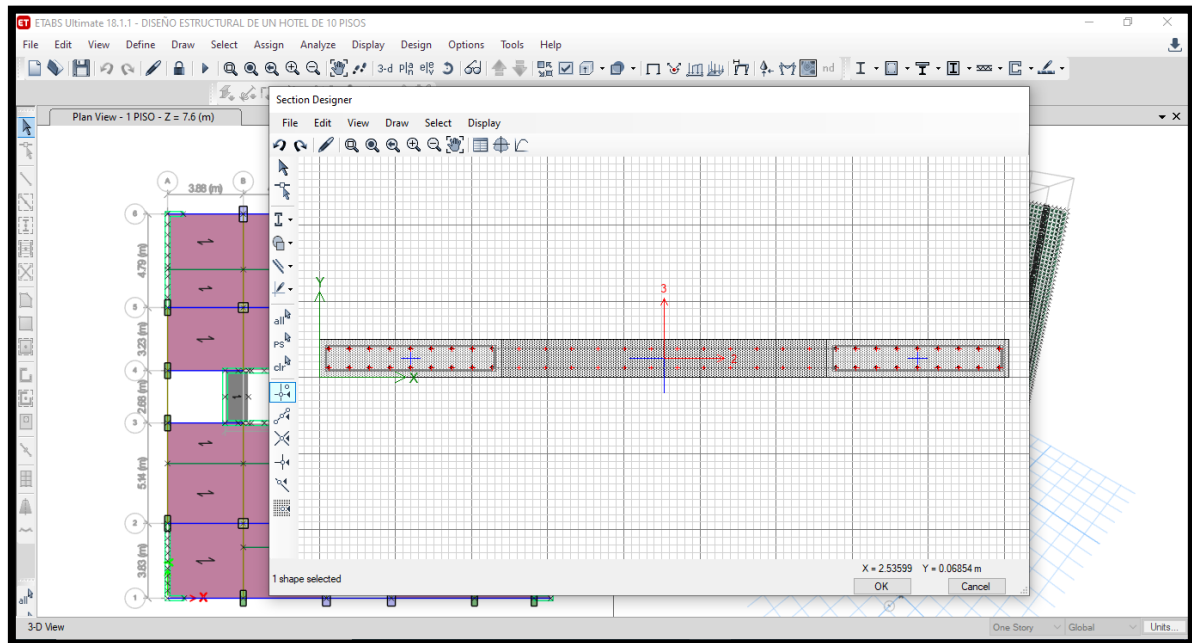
Vista en planta del armado de acero en la sección de: PL – 04.
